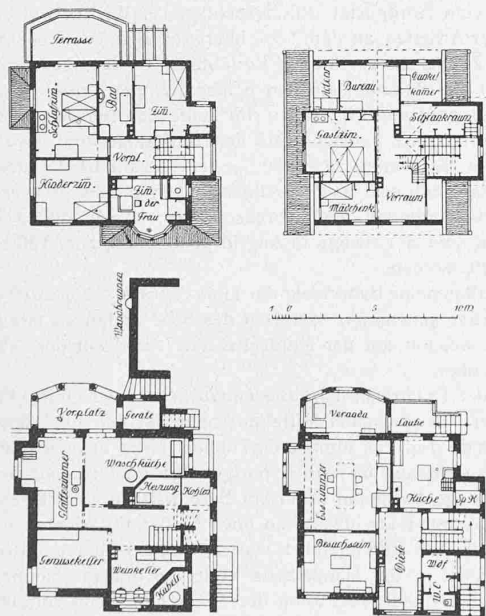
bis 5: Grundrisse; Abb. 6: Schnitt. — Masstab 1:400.
